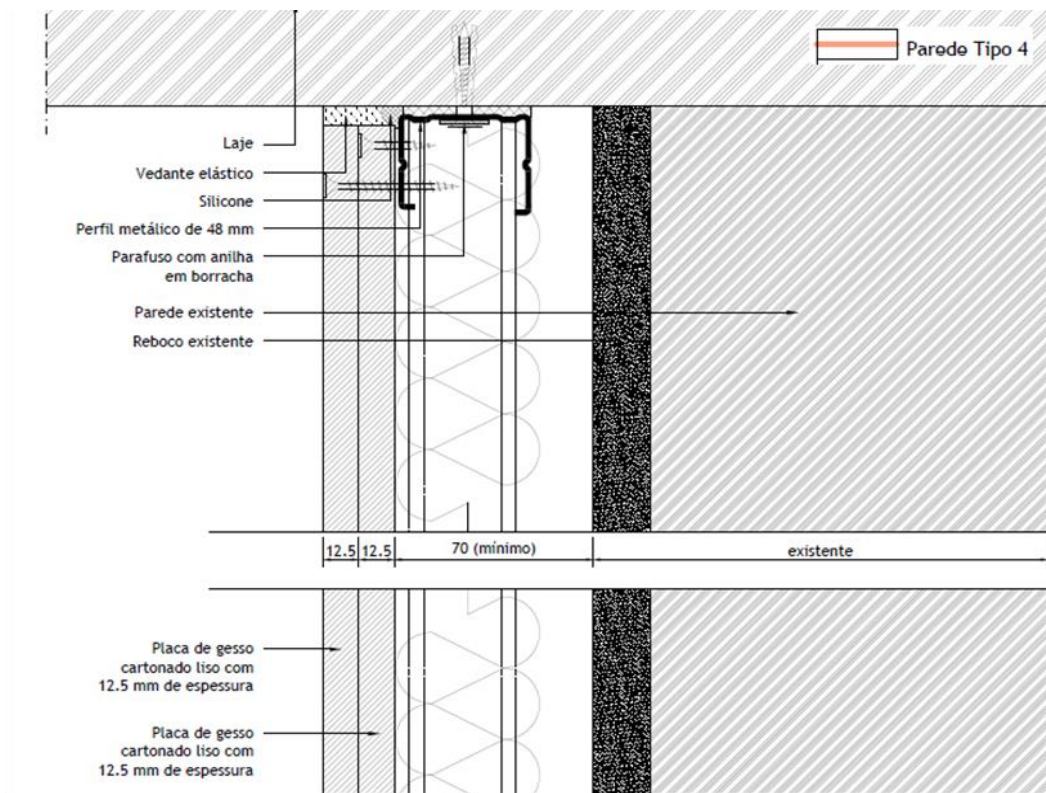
Corte construtivo da parede tipo 4 da Escola Secundária de Gondomar [53].
